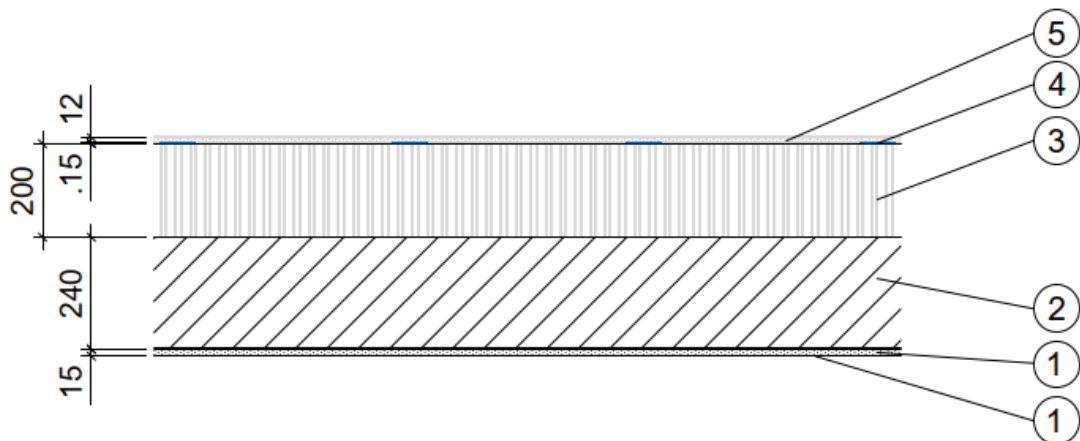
Mauerwerk mit Aussendämmung, hinterlüftet mit Fassadenverkleidung aus Faserzement
